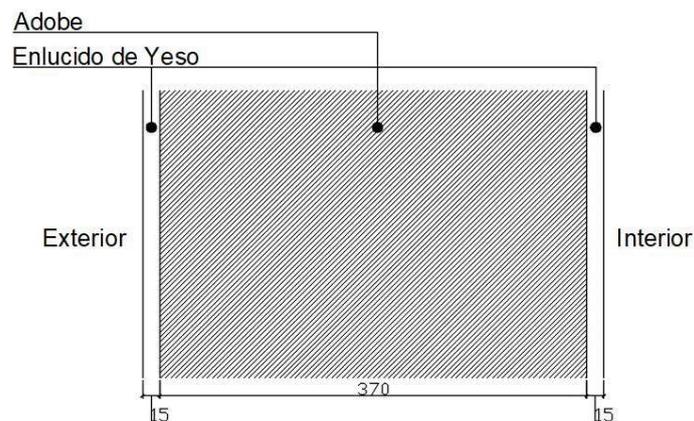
Sección de la Fachada tradicional cruceña.
